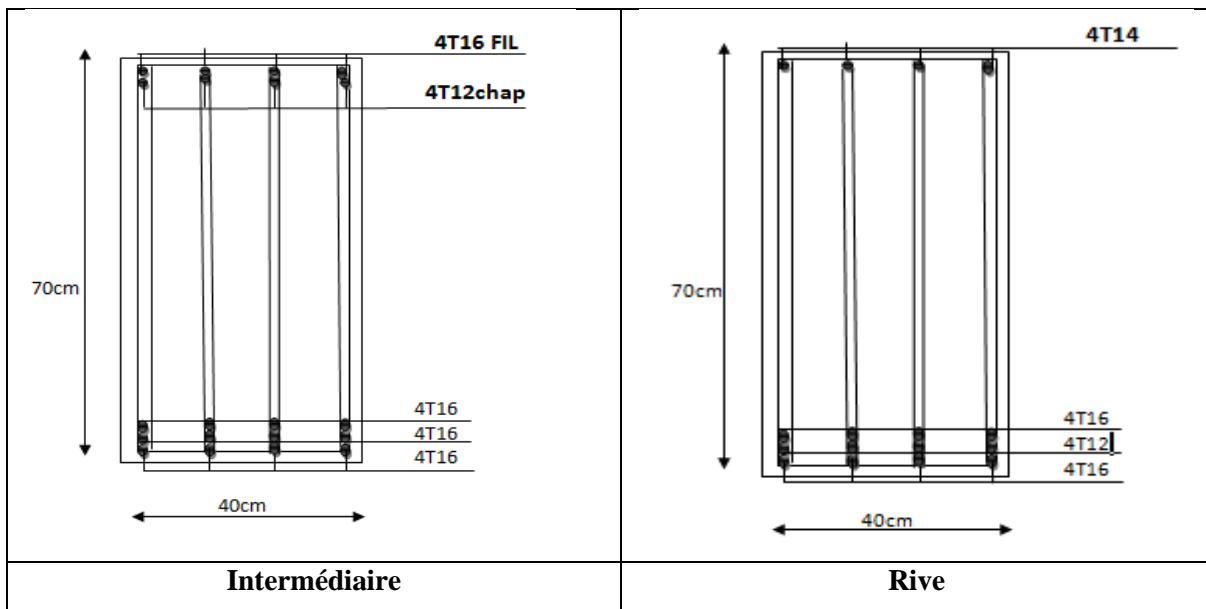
Ferrailage de la poutre de libage suivant le sens transversale.
